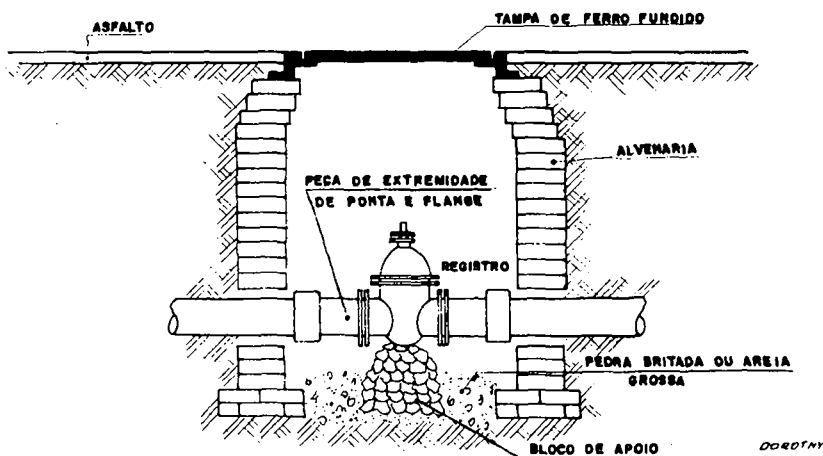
CAIXA DE PROTEÇÃO DE REGISTRO EM RUA PAVIMENTADA
